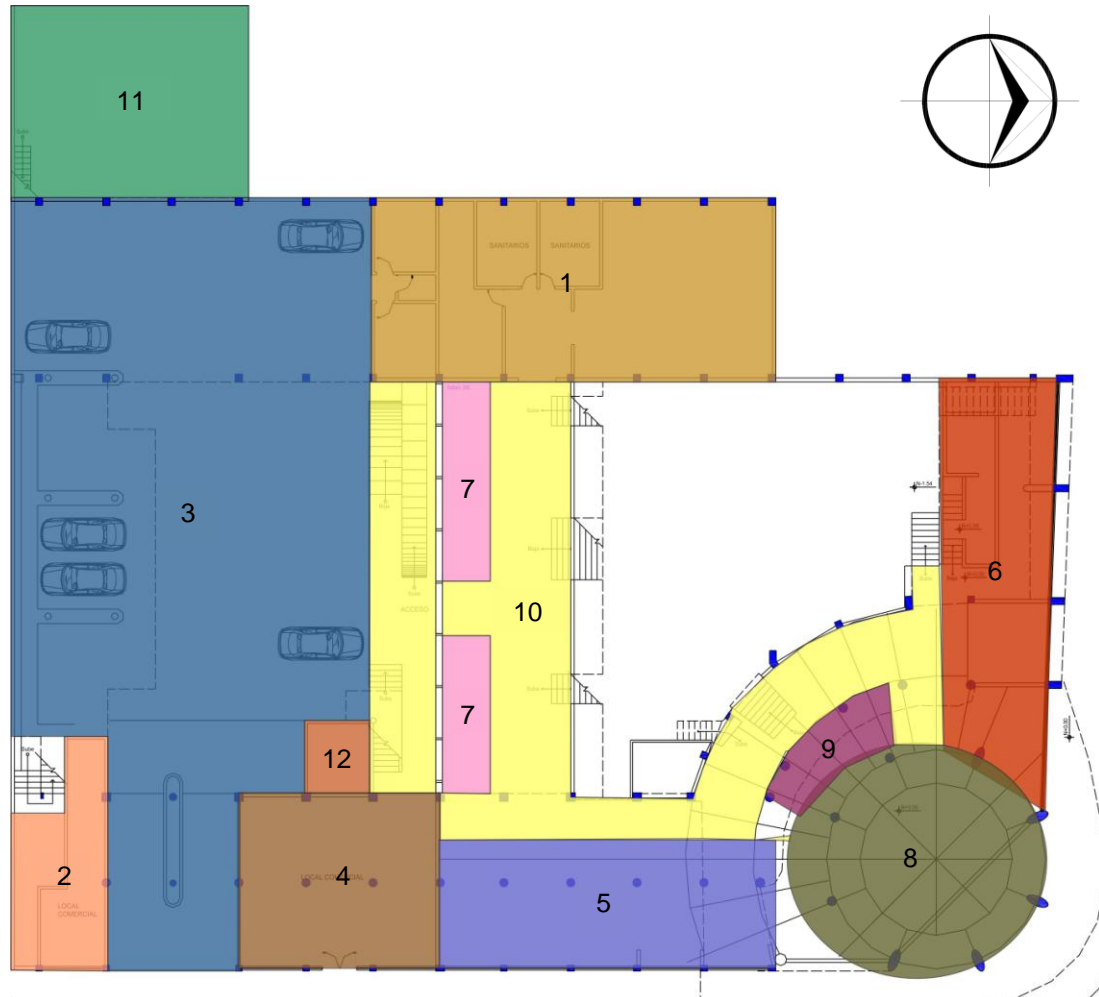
Esquema de zonificación planta baja. Fuente: Autoría propia. S/E.
